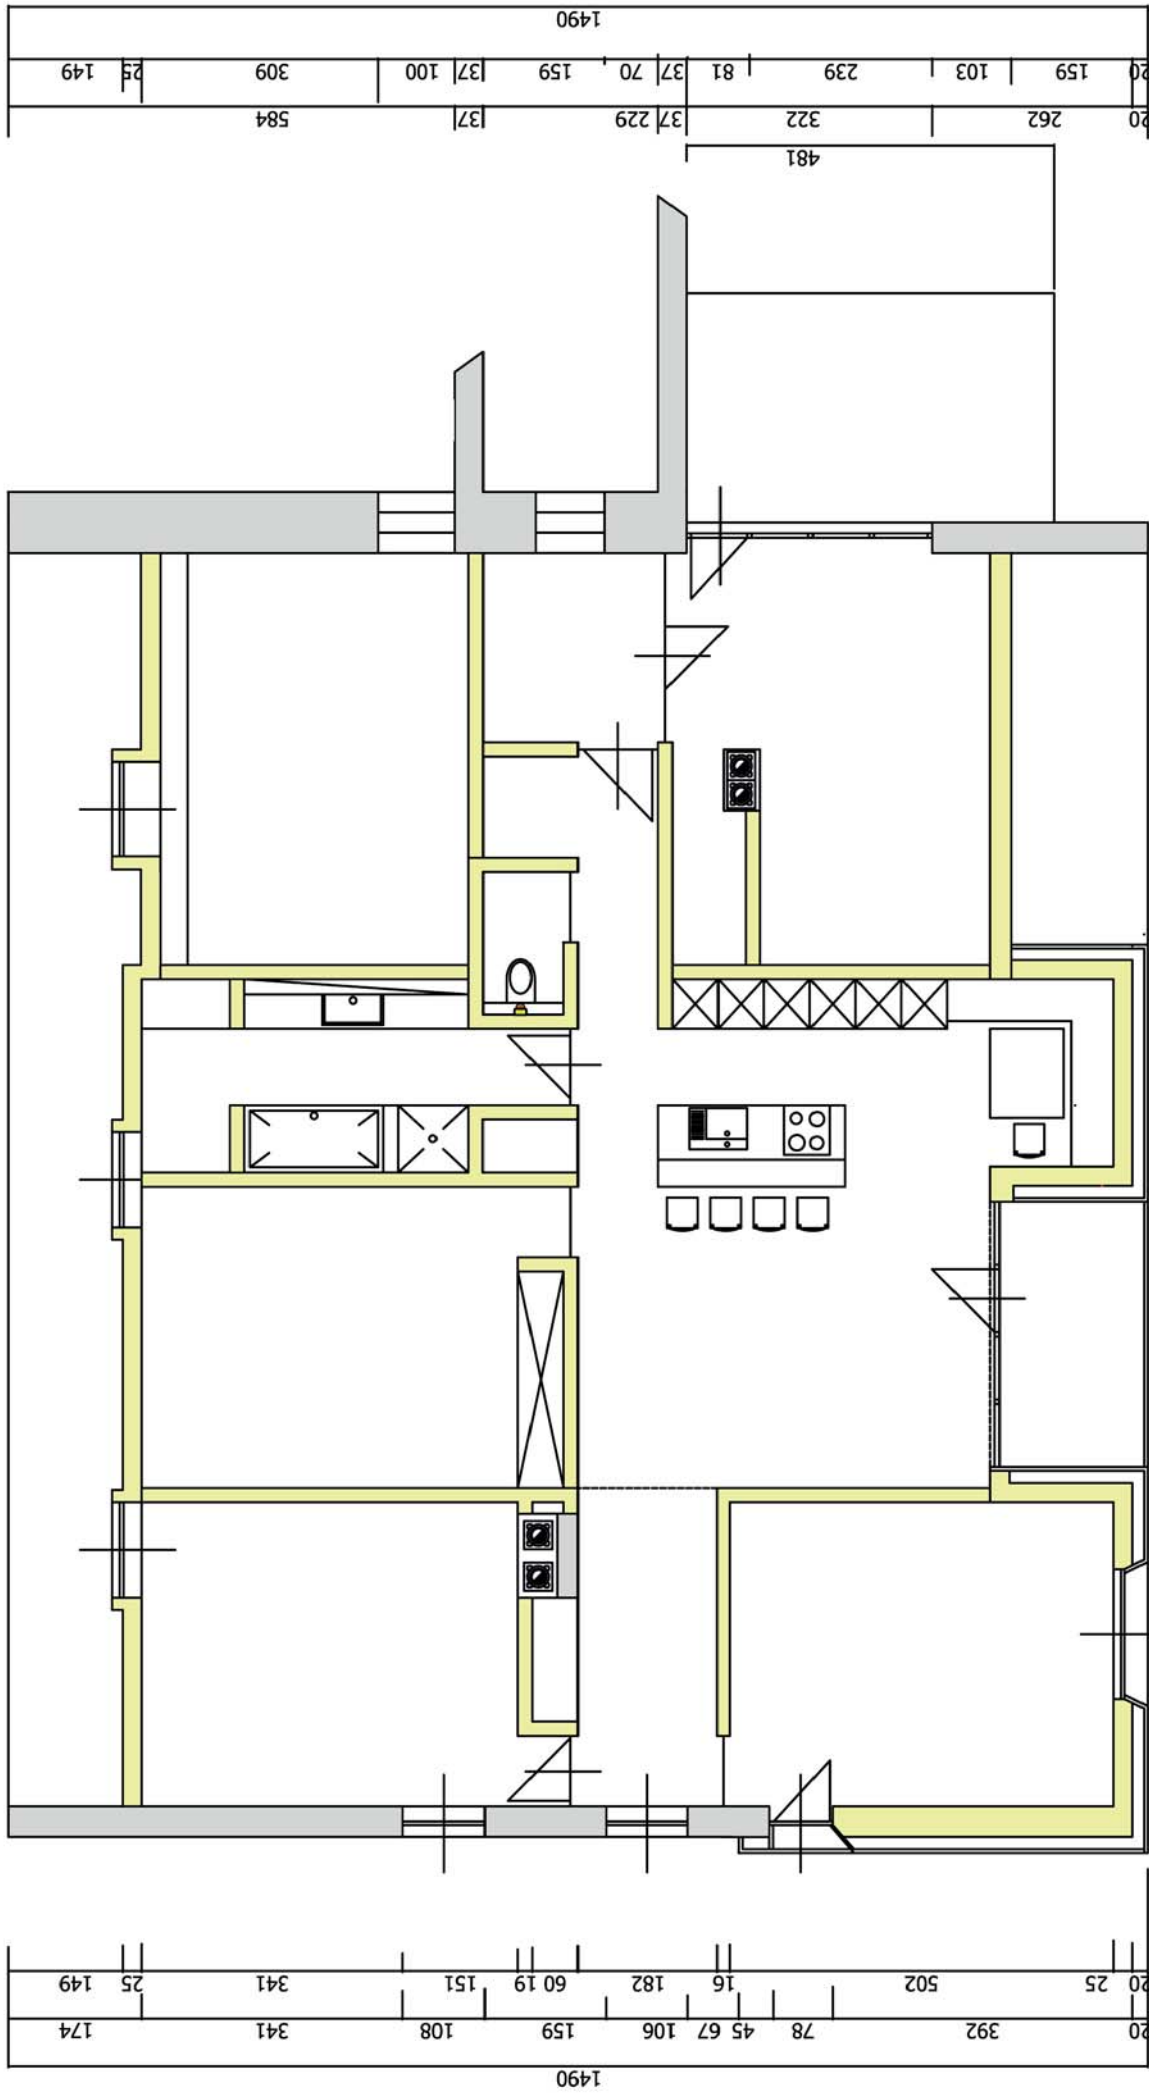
Grundriss 1:100 / groundplan 1:100
